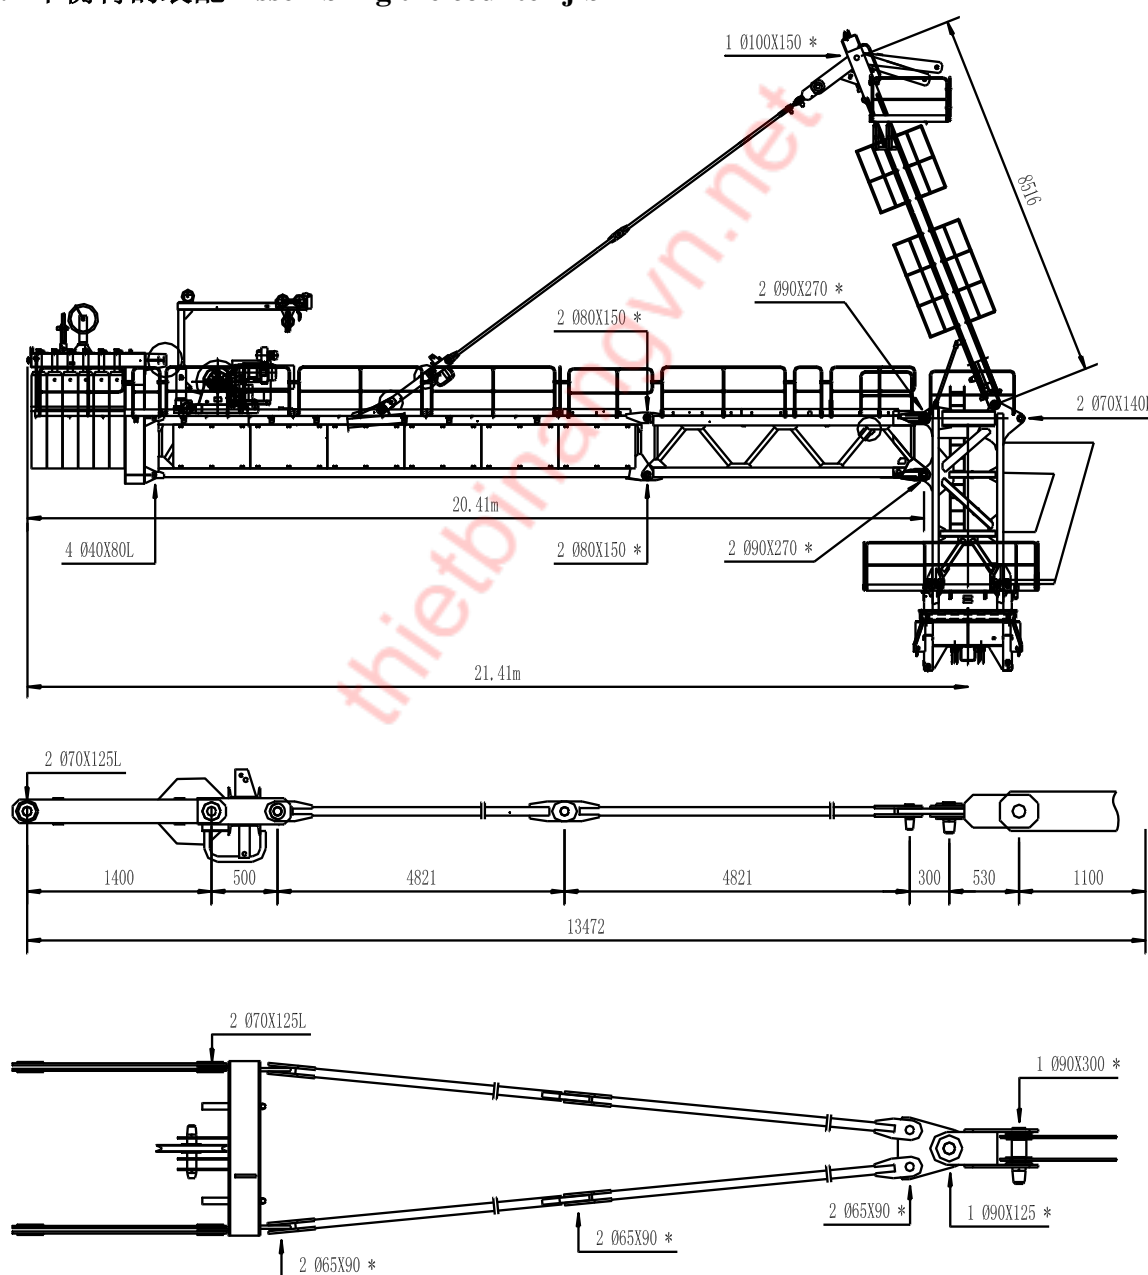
平衡臂的装配 Fig. 4-18 Assembling the counter-jib mast
